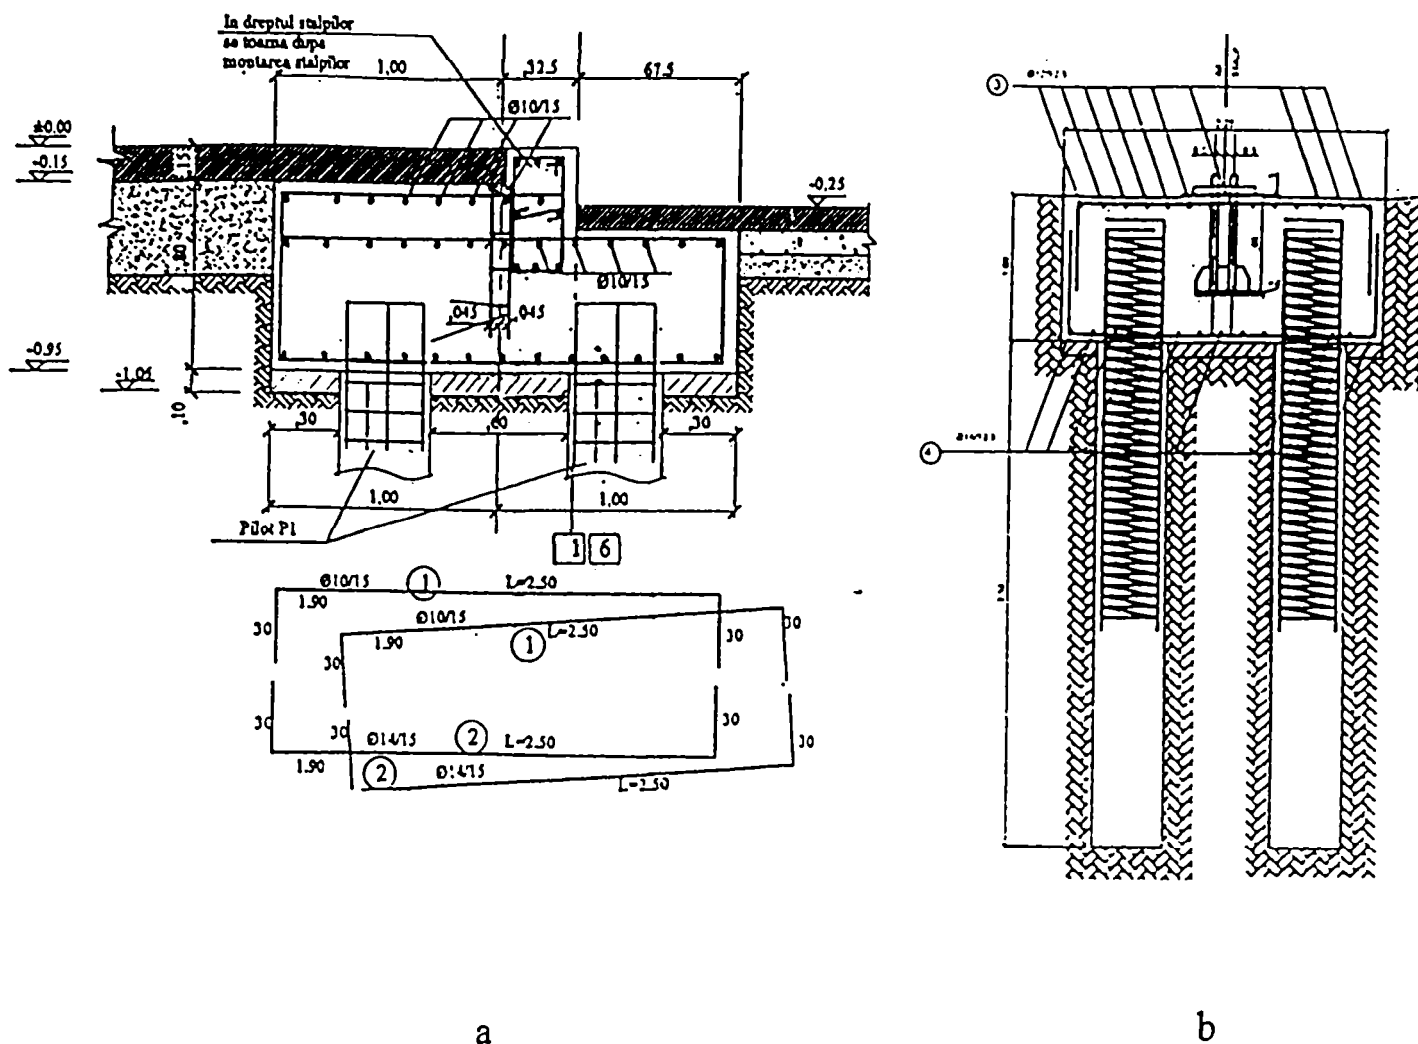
Detalii de legătură între piloți și cuzinetul de beton armat:
